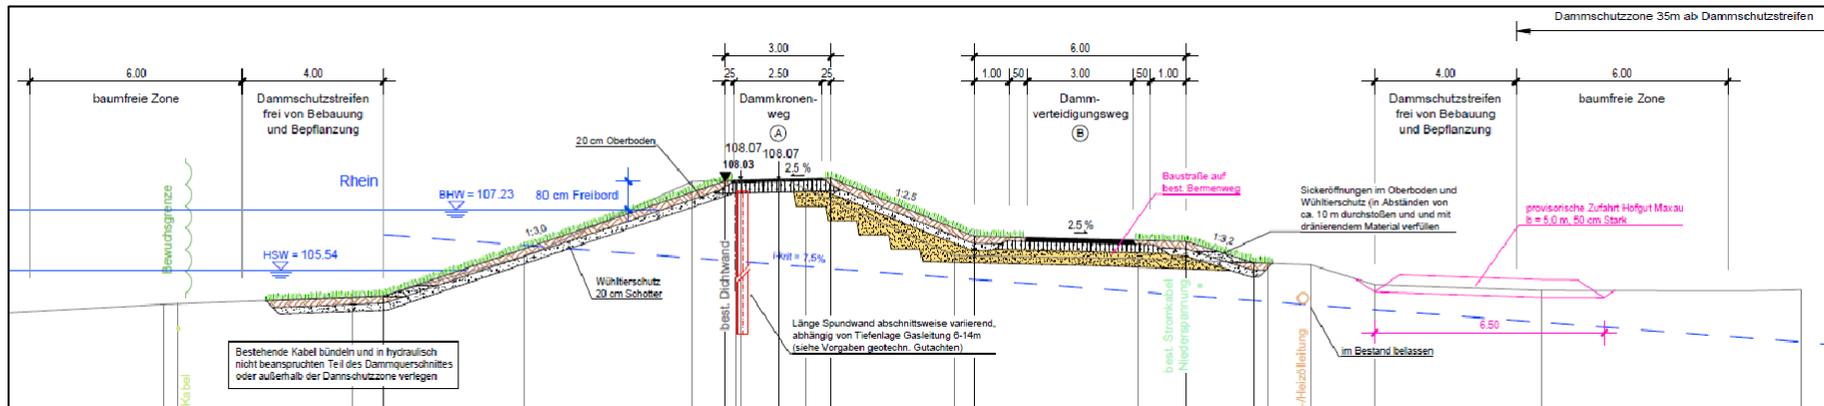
RQ 4 Abschnitt Ackerflächen mit Baustraße auf landseitigem Bermenweg und Besucherzufahrt Hofgut Maxau landseitig (Quelle: Anlage 2.1 zum Planfeststellungsantrag)
